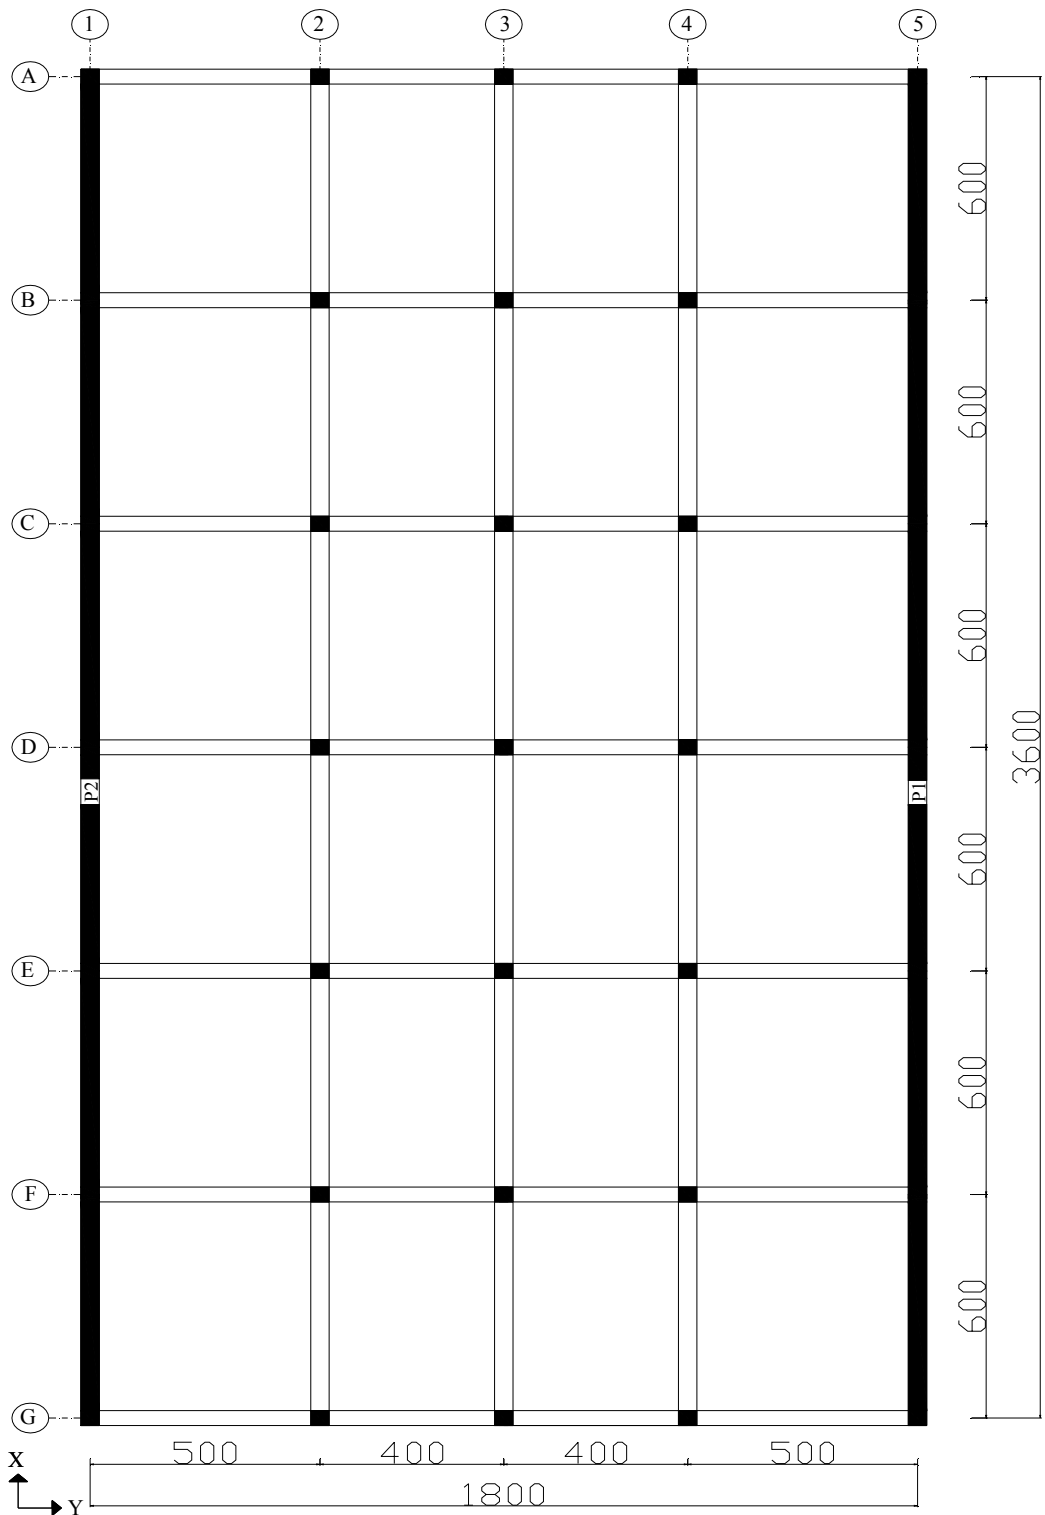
Örnek 5.10'nun kat kalıp planı
